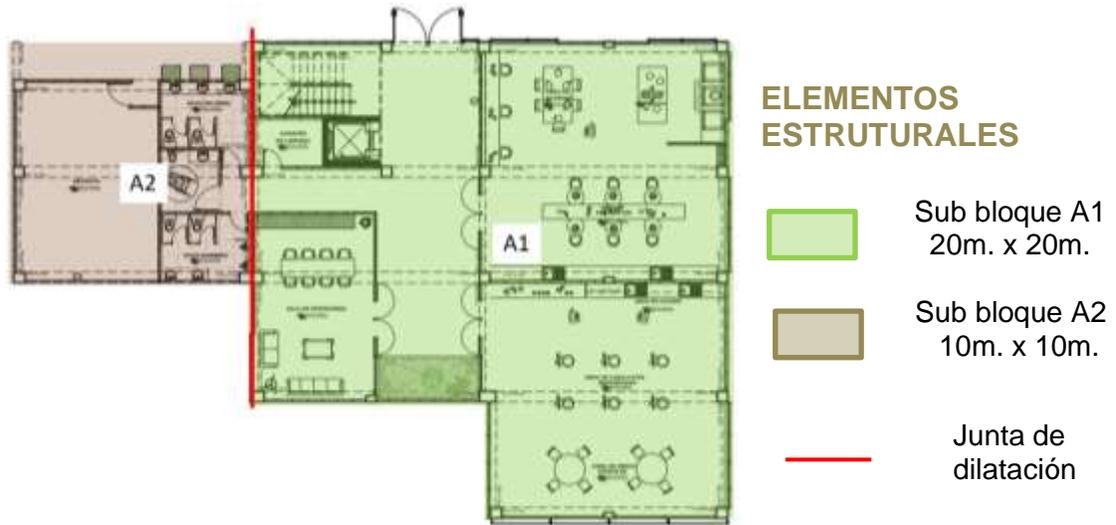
Diseño estructural Bloque A – Sub bloques. Elaboración Propia
